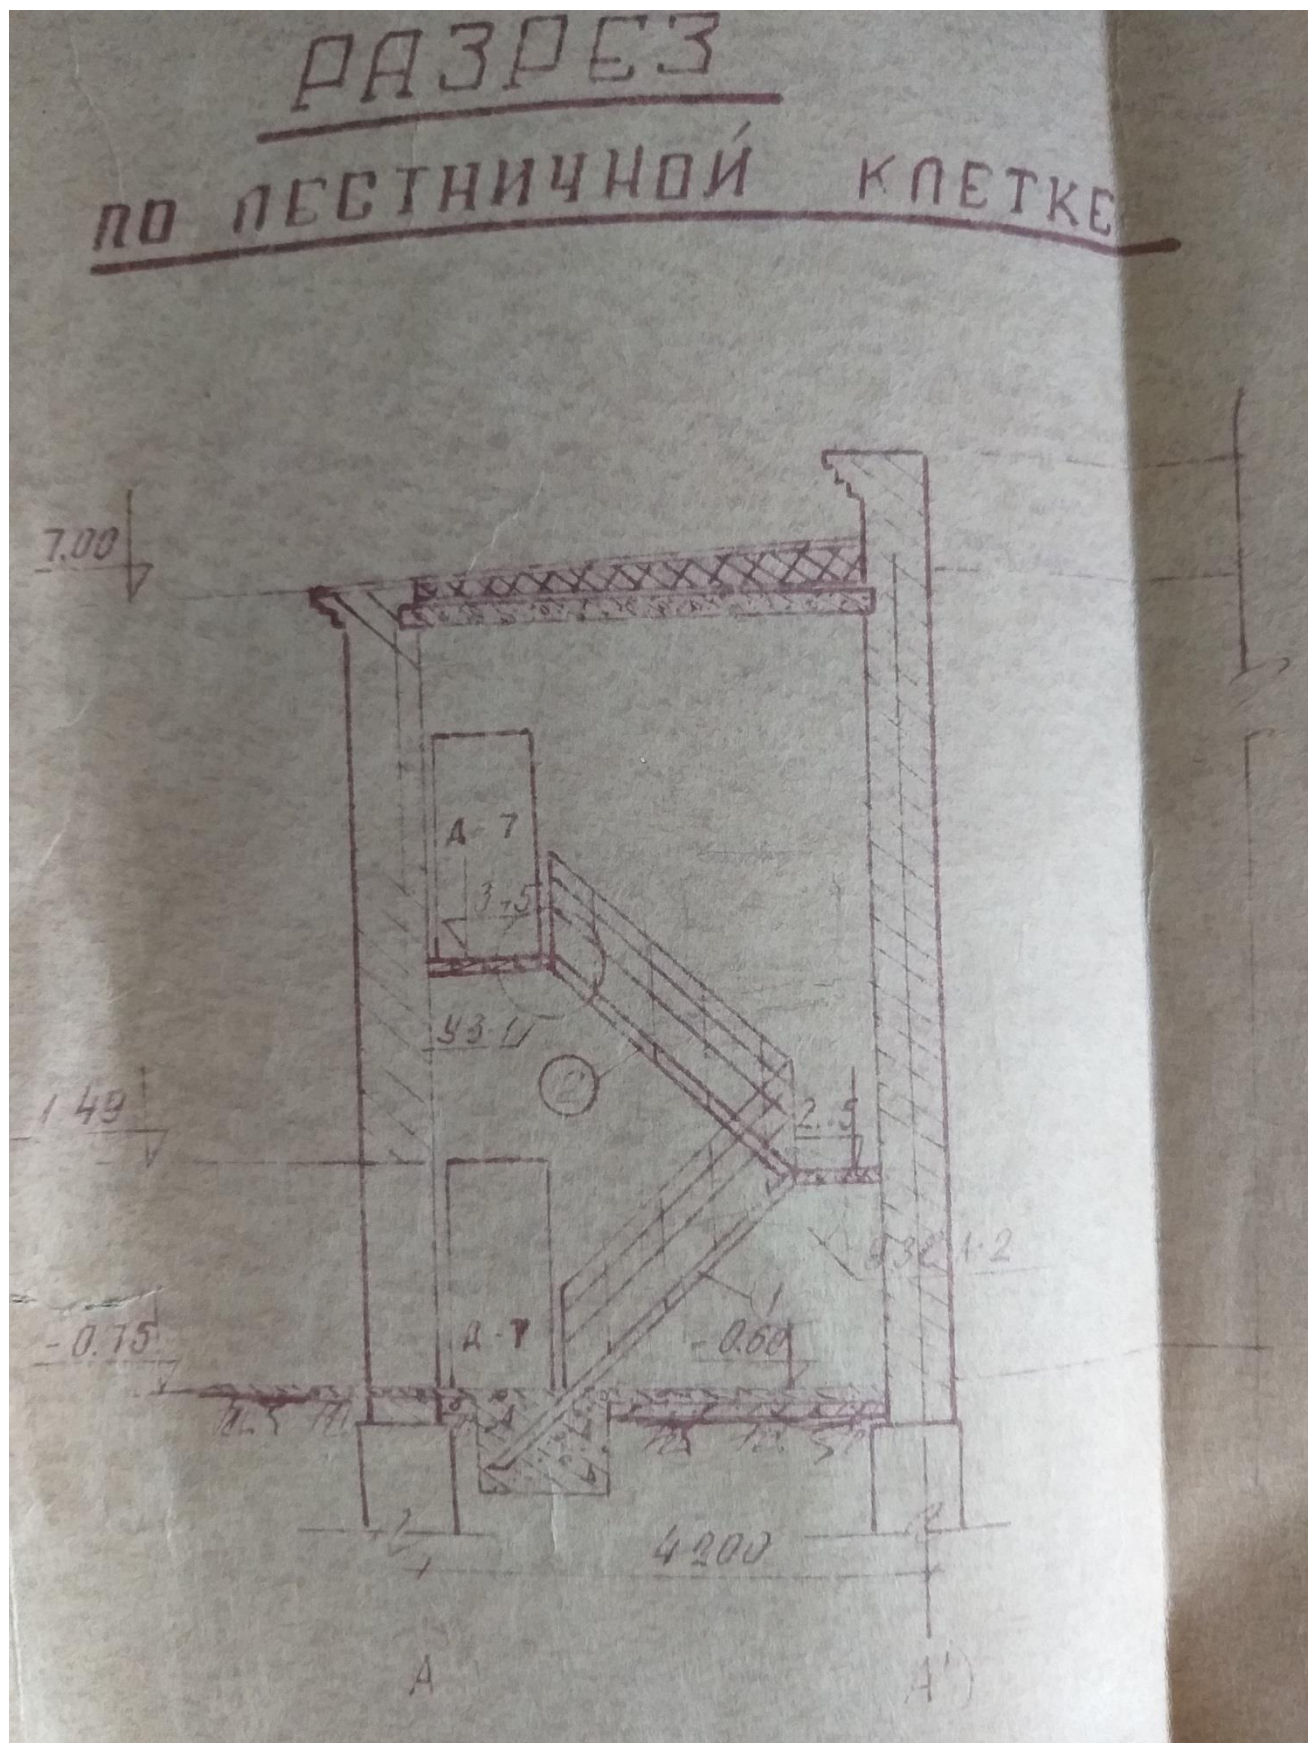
Разрез по лестничной клетке (к плану 1-го этажа)
